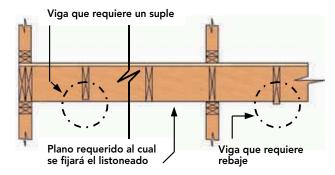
Corte de la plataforma donde se aprecia viga que requiere rebaje y viga que requiere de suplido.
